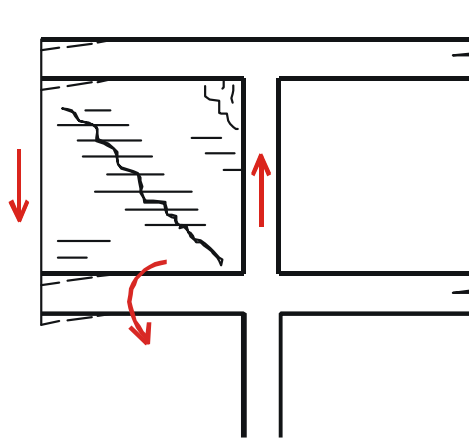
fissuras inclinadas em parede de alvenaria provocadas por deflexão da viga em balanço (THOMAZ, 1989)
